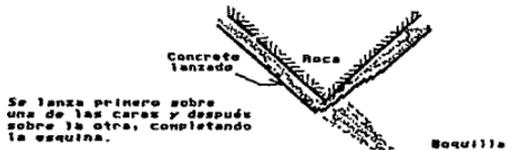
APLICACION DE CONCRETO LANZADO EN ESQUINAS EXTERIORES (VERTICES).
